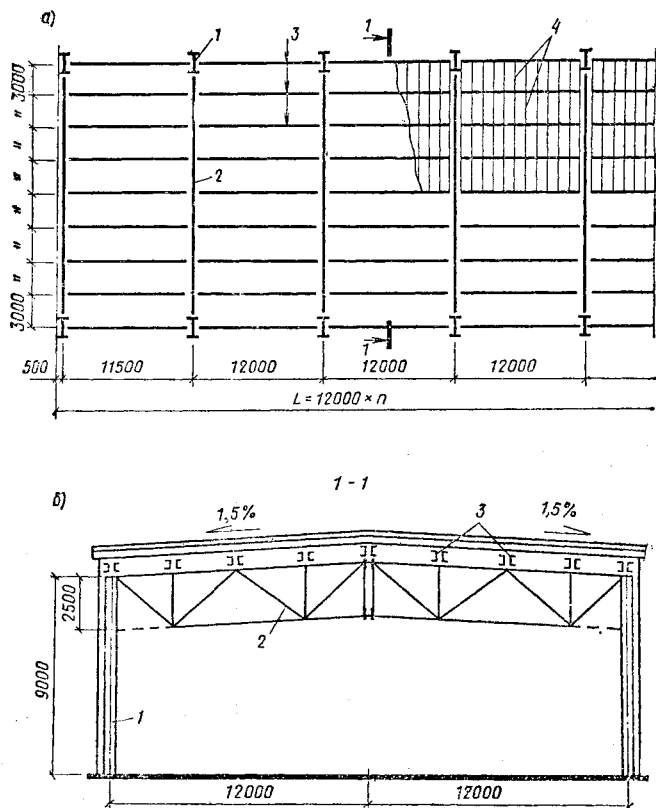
План (а) и поперечный разрез (б) покрытия к примеру 8.5
